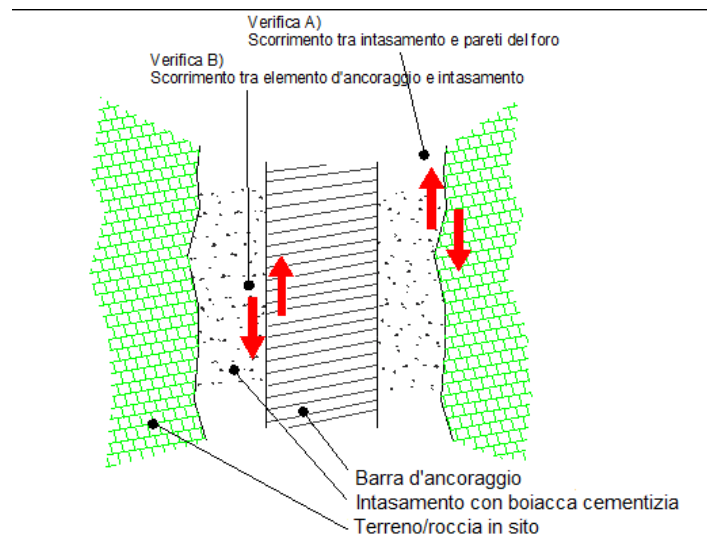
Verifiche rispetto allo sfilamento dell'ancoraggio.
